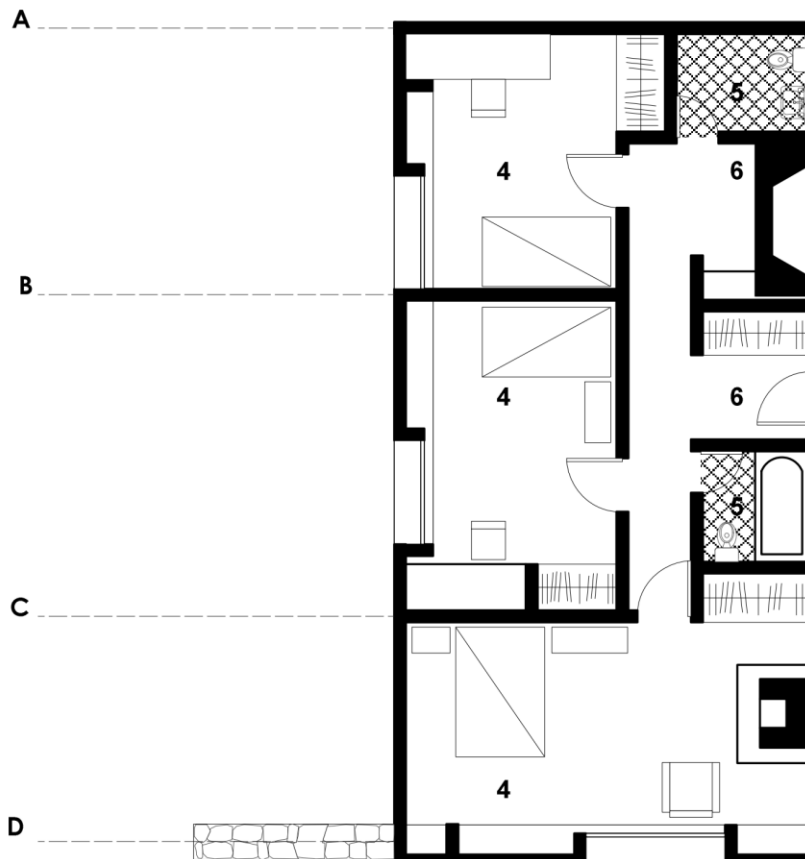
Planta baja, zonificación bloque 1. Fuente: Autor.
